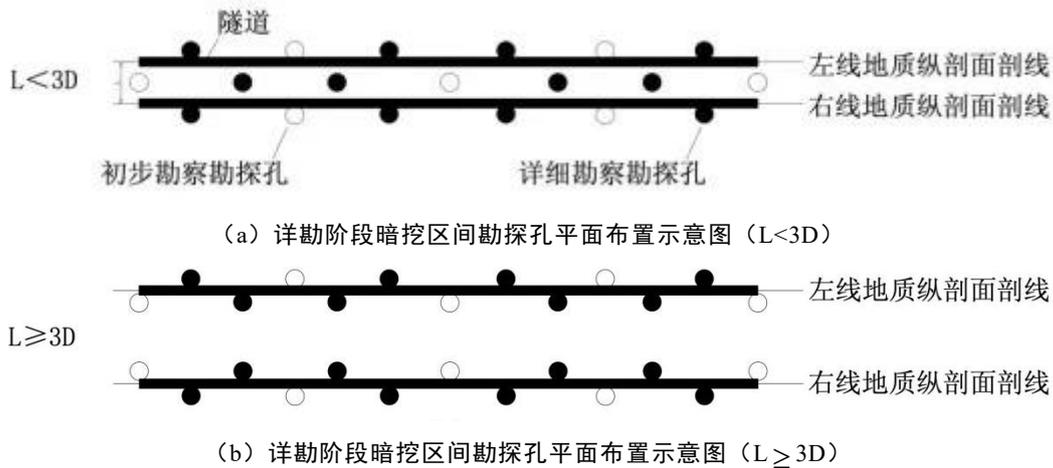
详勘阶段暗挖区间勘探孔平面布置示意图
